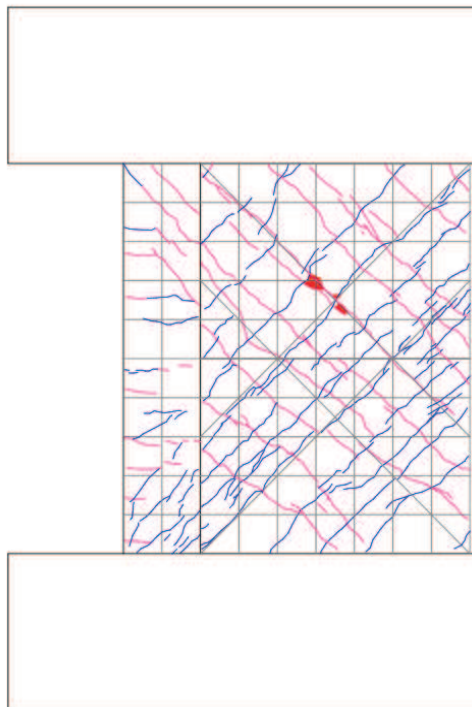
試験体 S-06-DIV 事前加力終了時 (6/1000rad.) ひび割れ図
